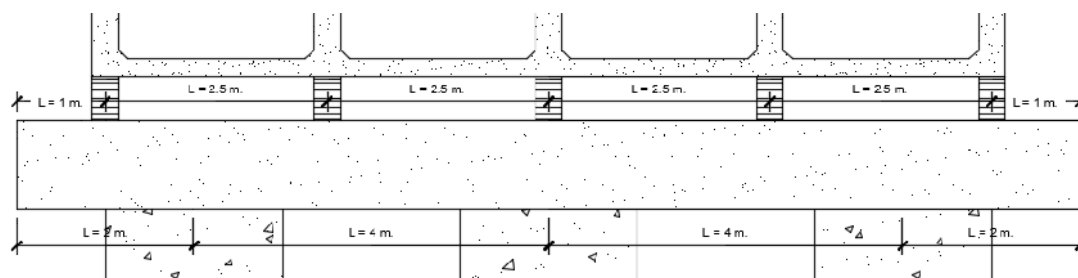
Detalle de viga cabezal (Fuente: elaboración propia)
